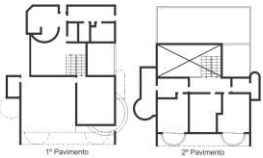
Planta baixa da casa tipo do condomínio Recanto da Serra.
